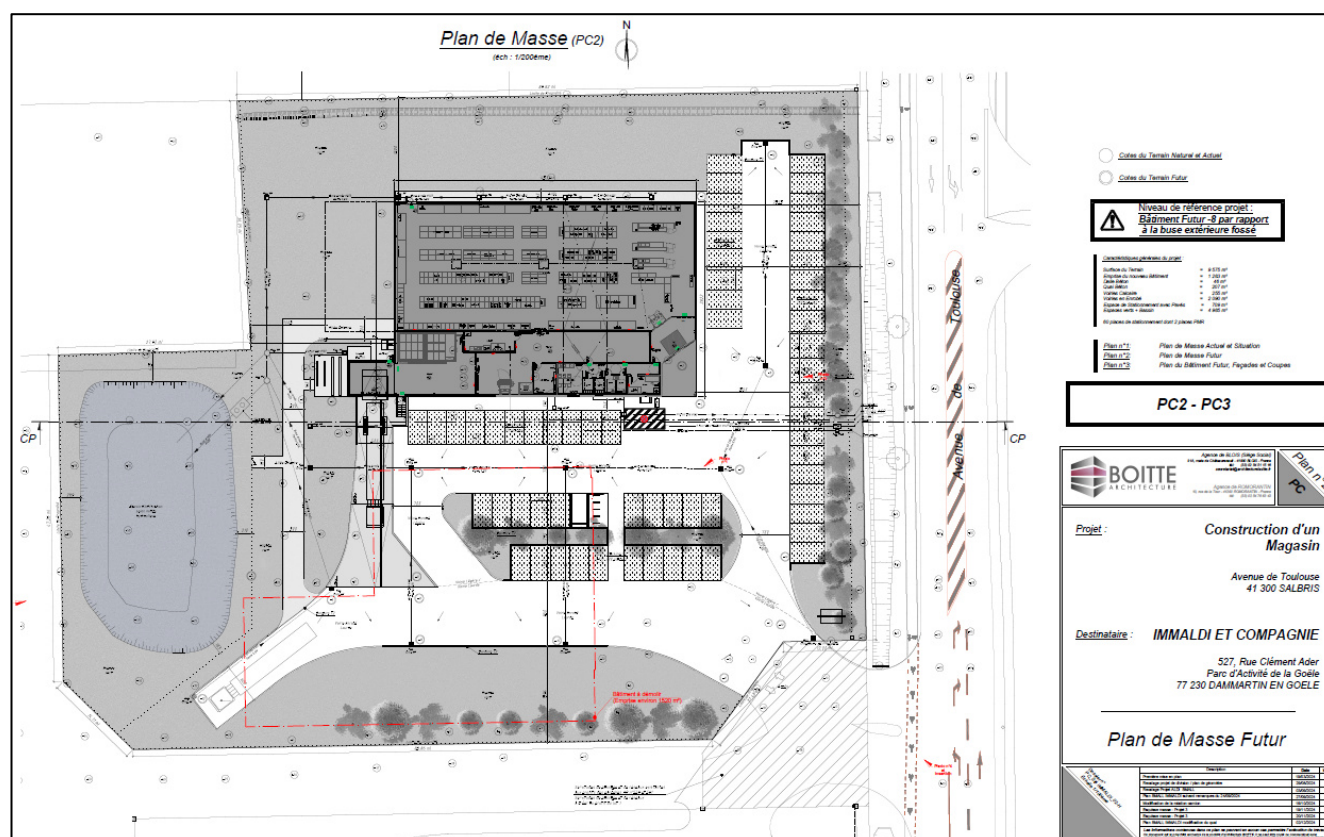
Plan de masse du projet (réf. PC2-PC3, BOITE ARCHITECTURE, 02/12/2024)
